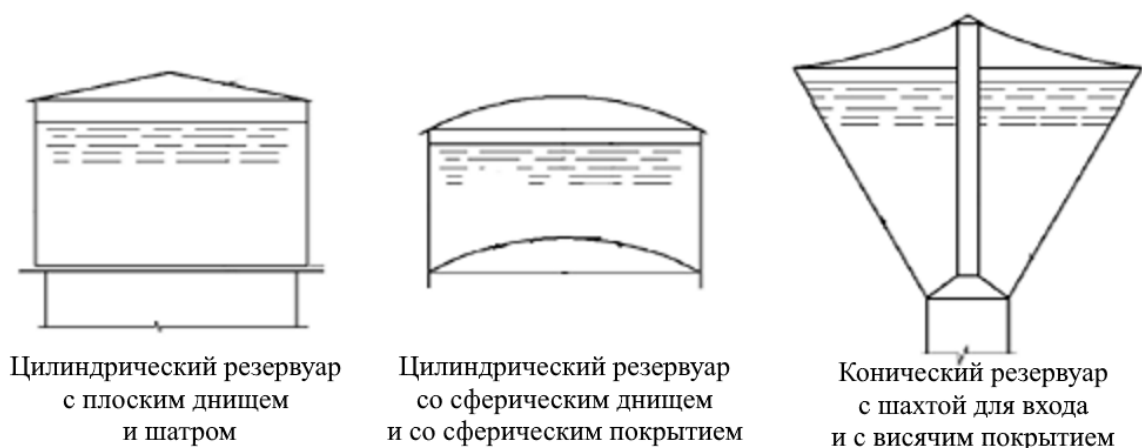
Схемы резервуаров водонапорных башен
